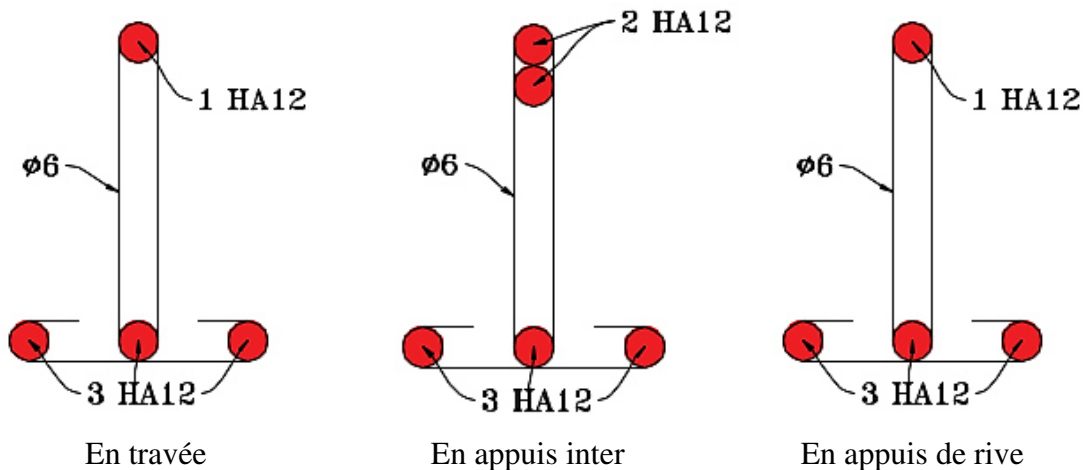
Schémas de ferrillage des poutrelles de la terrasse.
